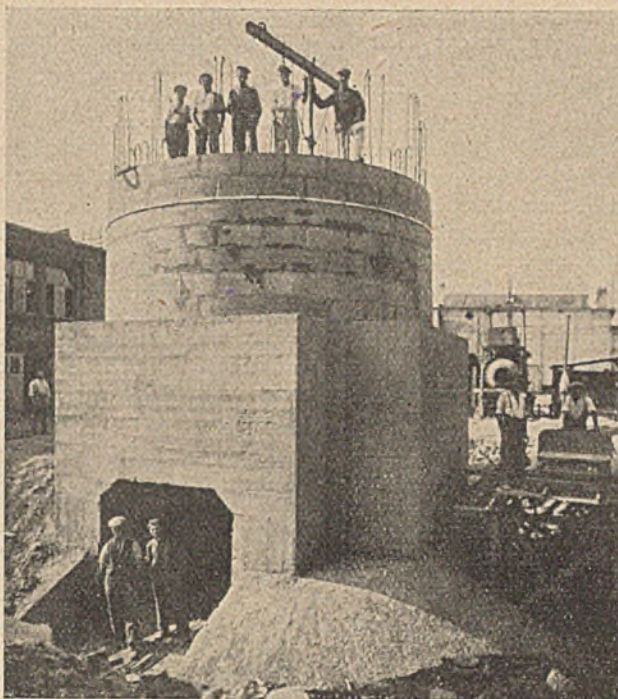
Unterer Teil des Eisenbetonschornsteins mit den beiden Rauchkanaleinmündungen.
